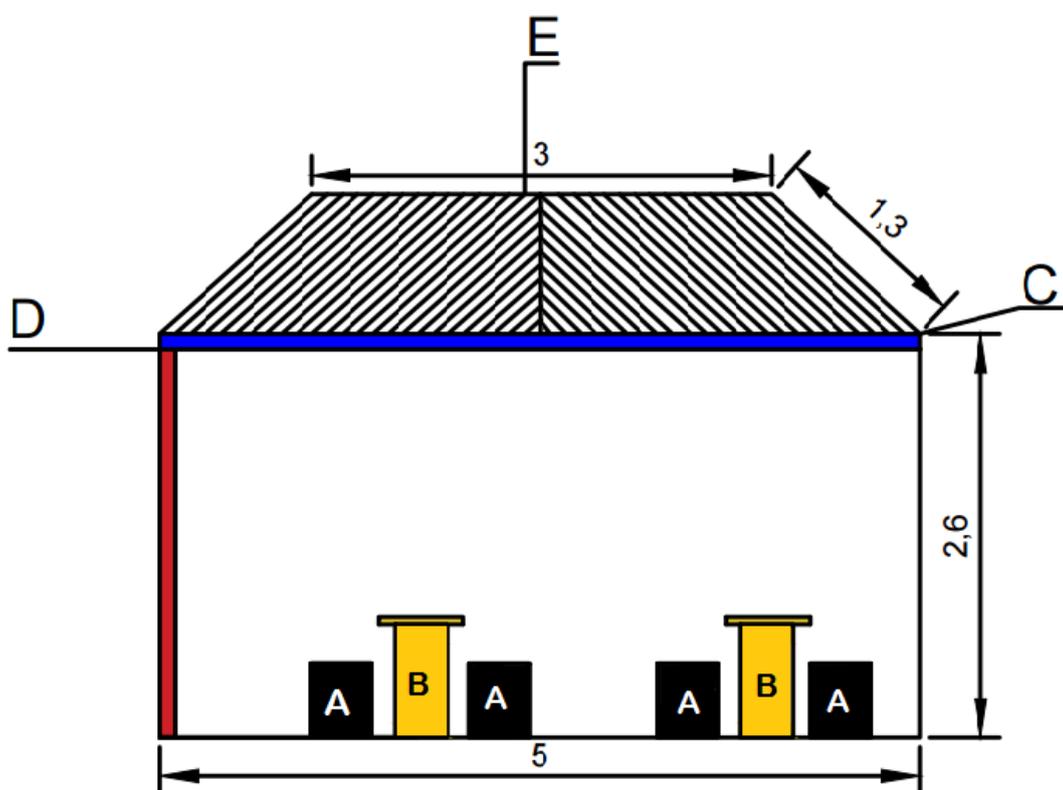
Praça do Estudo. Cruzamento da Avenida José Callegari com a Rua Sergipe.
